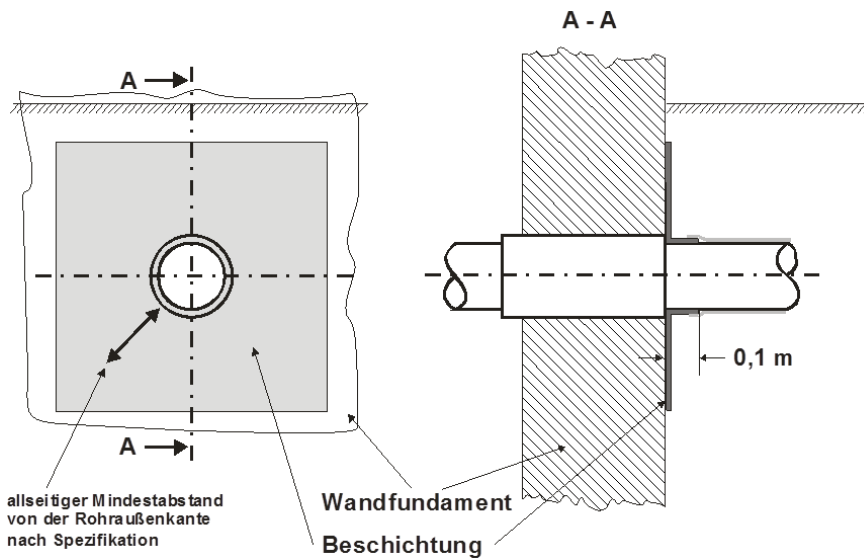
Beschichtungsprinzip bei Wanddurchführungen von Stahlbetonbauwerken
